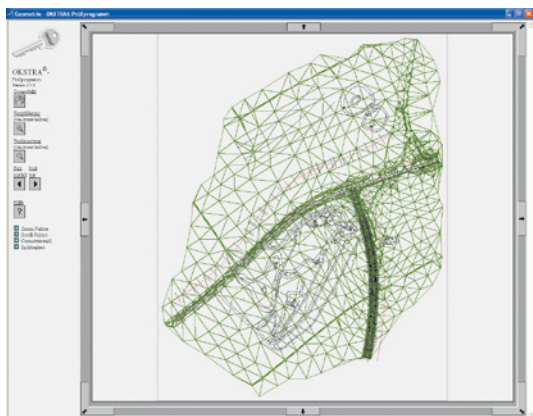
Grundplan aus dem Entwurf mit Achsen, Längsschnitt, Querprofilen und DGM
